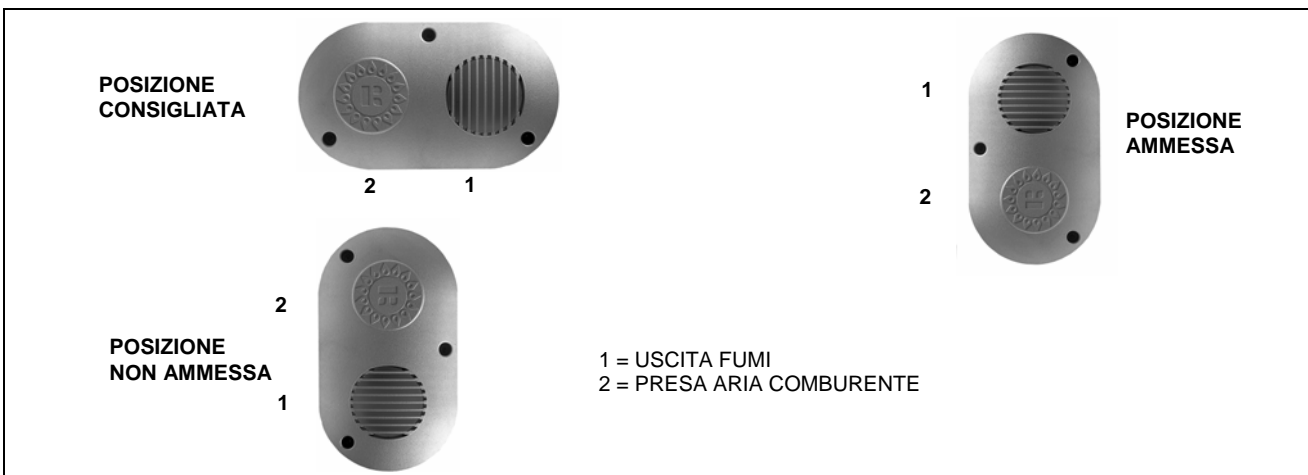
POSIZIONE TERMINALE A PARETE
